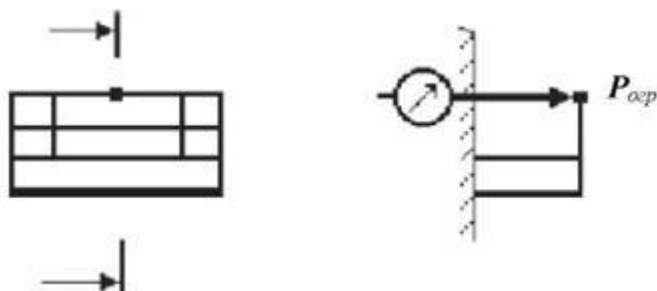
Схема приложения испытательной нагрузки для ограждения кровли, а также марша и площадки маршевой лестницы
